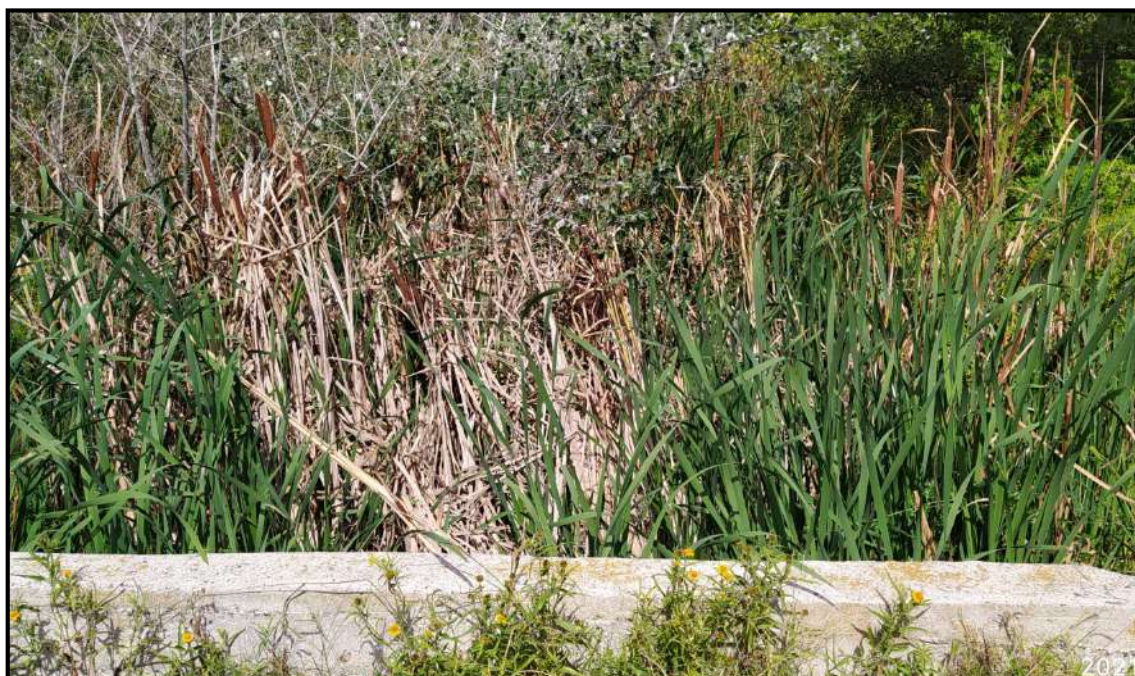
Canal Sur Calle 63 – Vista hacia aguas abajo – Alcantarilla Entrada Barrio
